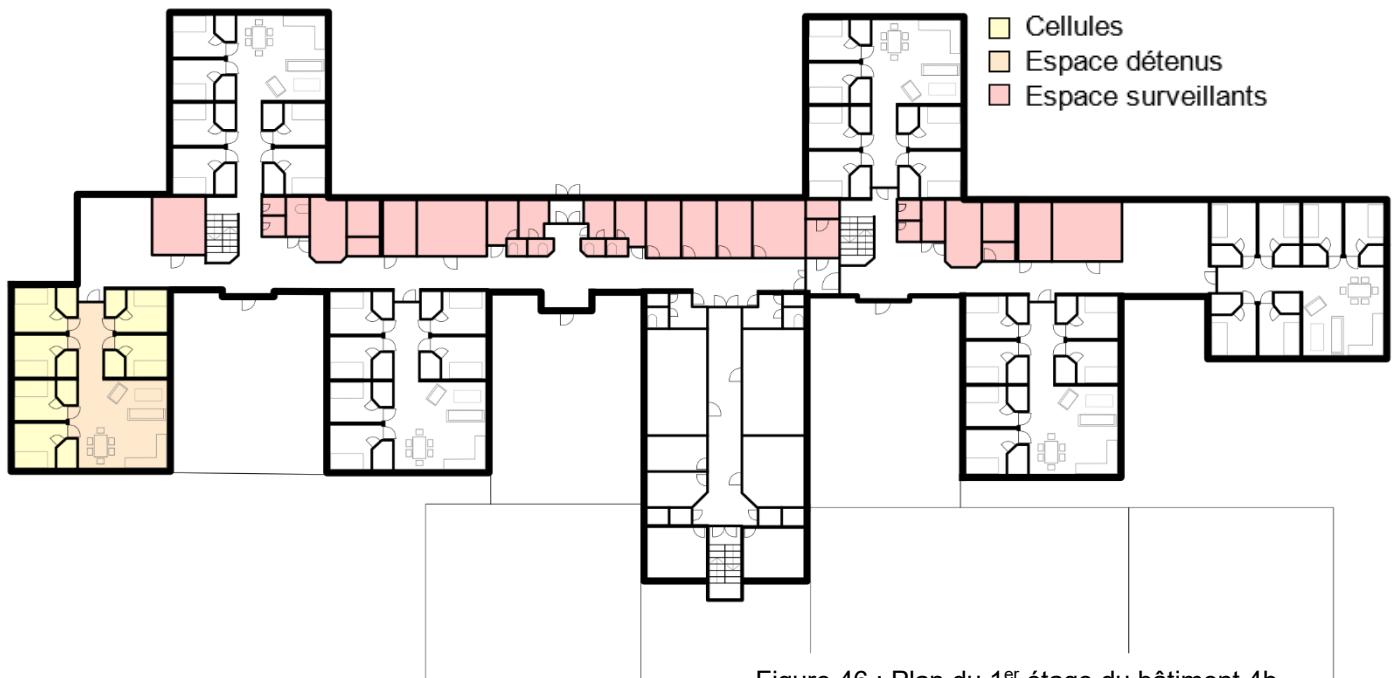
Plan du 1^{er} étage du bâtiment 4b
